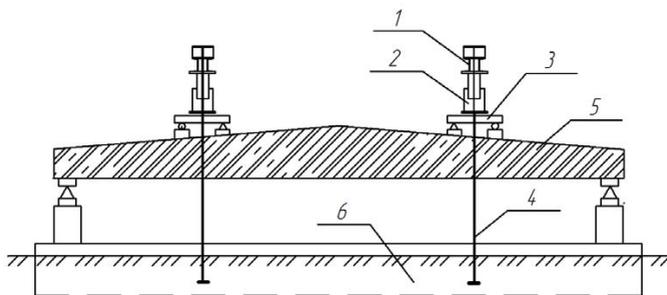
Схема испытания железобетонной балки на стационарном стенде
